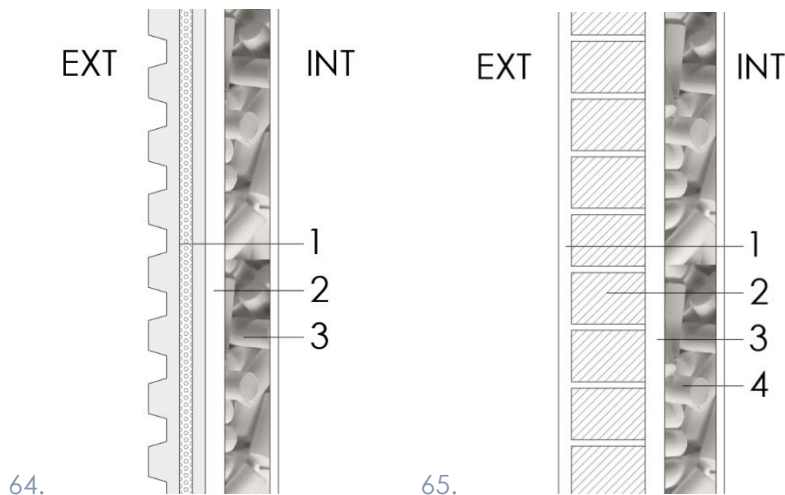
y 65. Detalles de envolvente Tipo 1 y Tipo 2 (secciones verticales) con aislamiento de filtros en Burgos. Fuente: Elaboración propia
